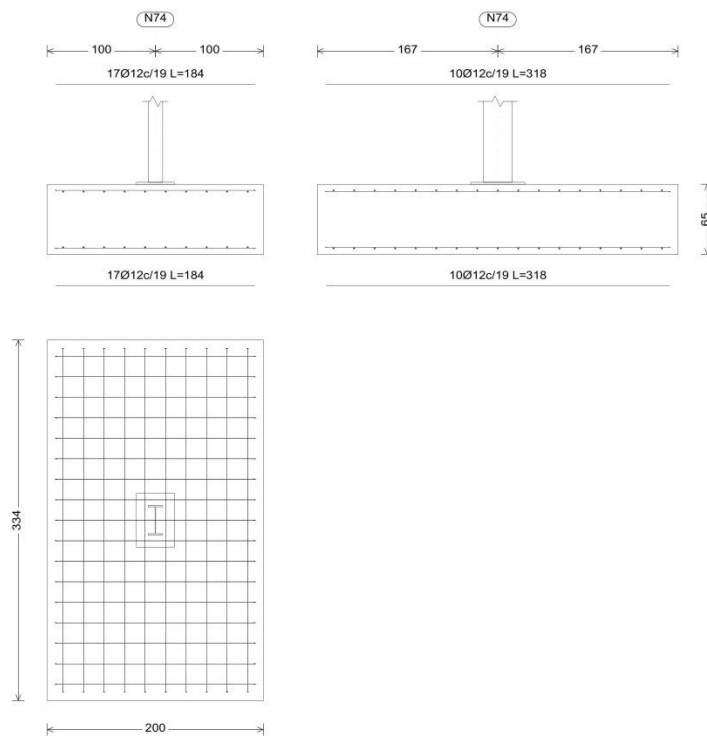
Zapata tipo 1. Fuente: Elaboración propia a partir de CYPE 3D
